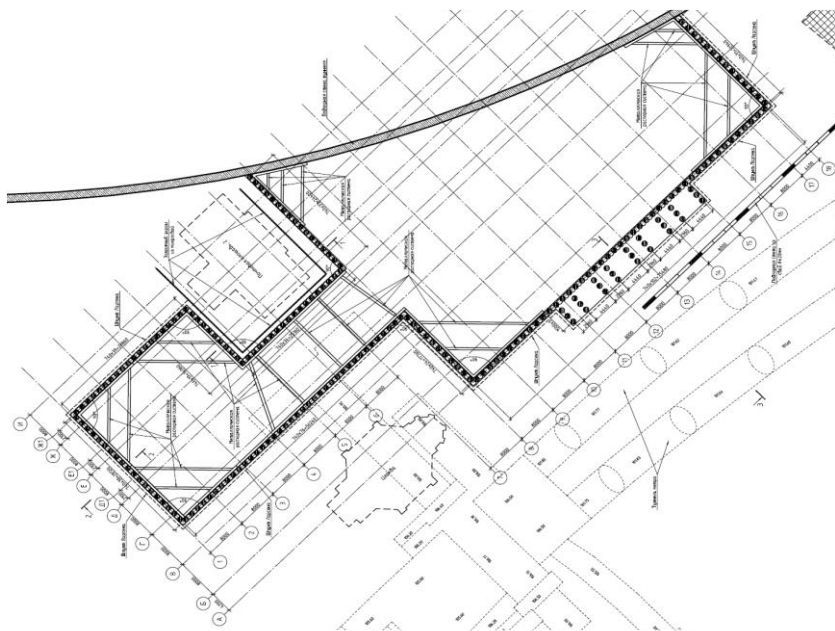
План розташування конструкцій огороження котловану і ближніх будівель: церква Різдва Христового, Поштовий будинок, будівля «Київпастрансу»
